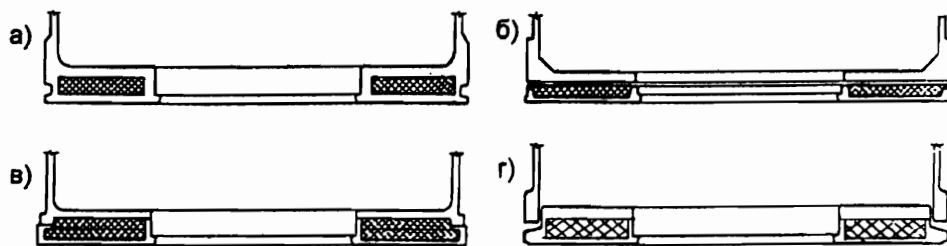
Конструкции наружных стен объёмно-блочных зданий: а – с утеплением наружной стены в процессе бетонирования блока; б, в – с утеплением двухслойной приставной панелью; г – с наружной стеновой панелью трёхслойной конструкции
